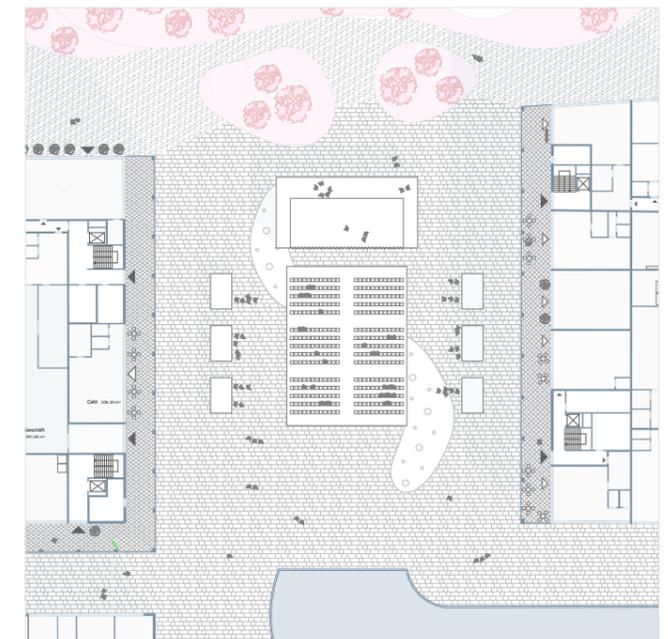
Grundriss Stadtplatz in M 1:500
